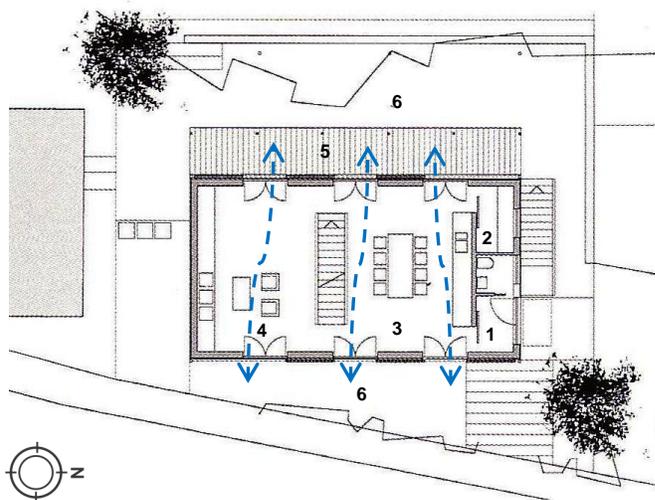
Planta Baixa térreo - Residência Schlude.
